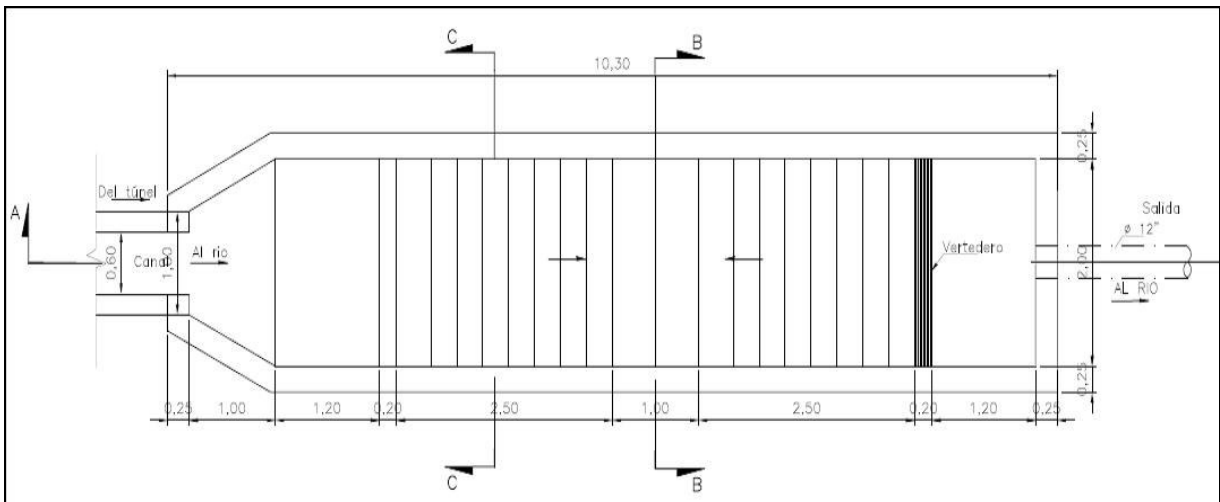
Planta del desarenador para aguas provenientes de la construcción del túnel
